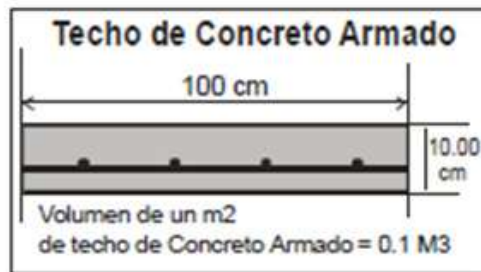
Cubierta de la sección esquemática en hormigón armado, con el cálculo de volumen de concreto en un techo m^2 .
